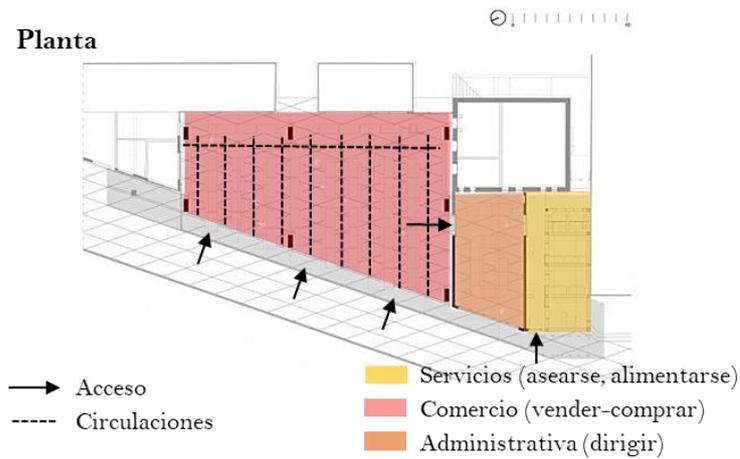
Planta del mercado del puerto. Año: 2015. Fuente: Public space
